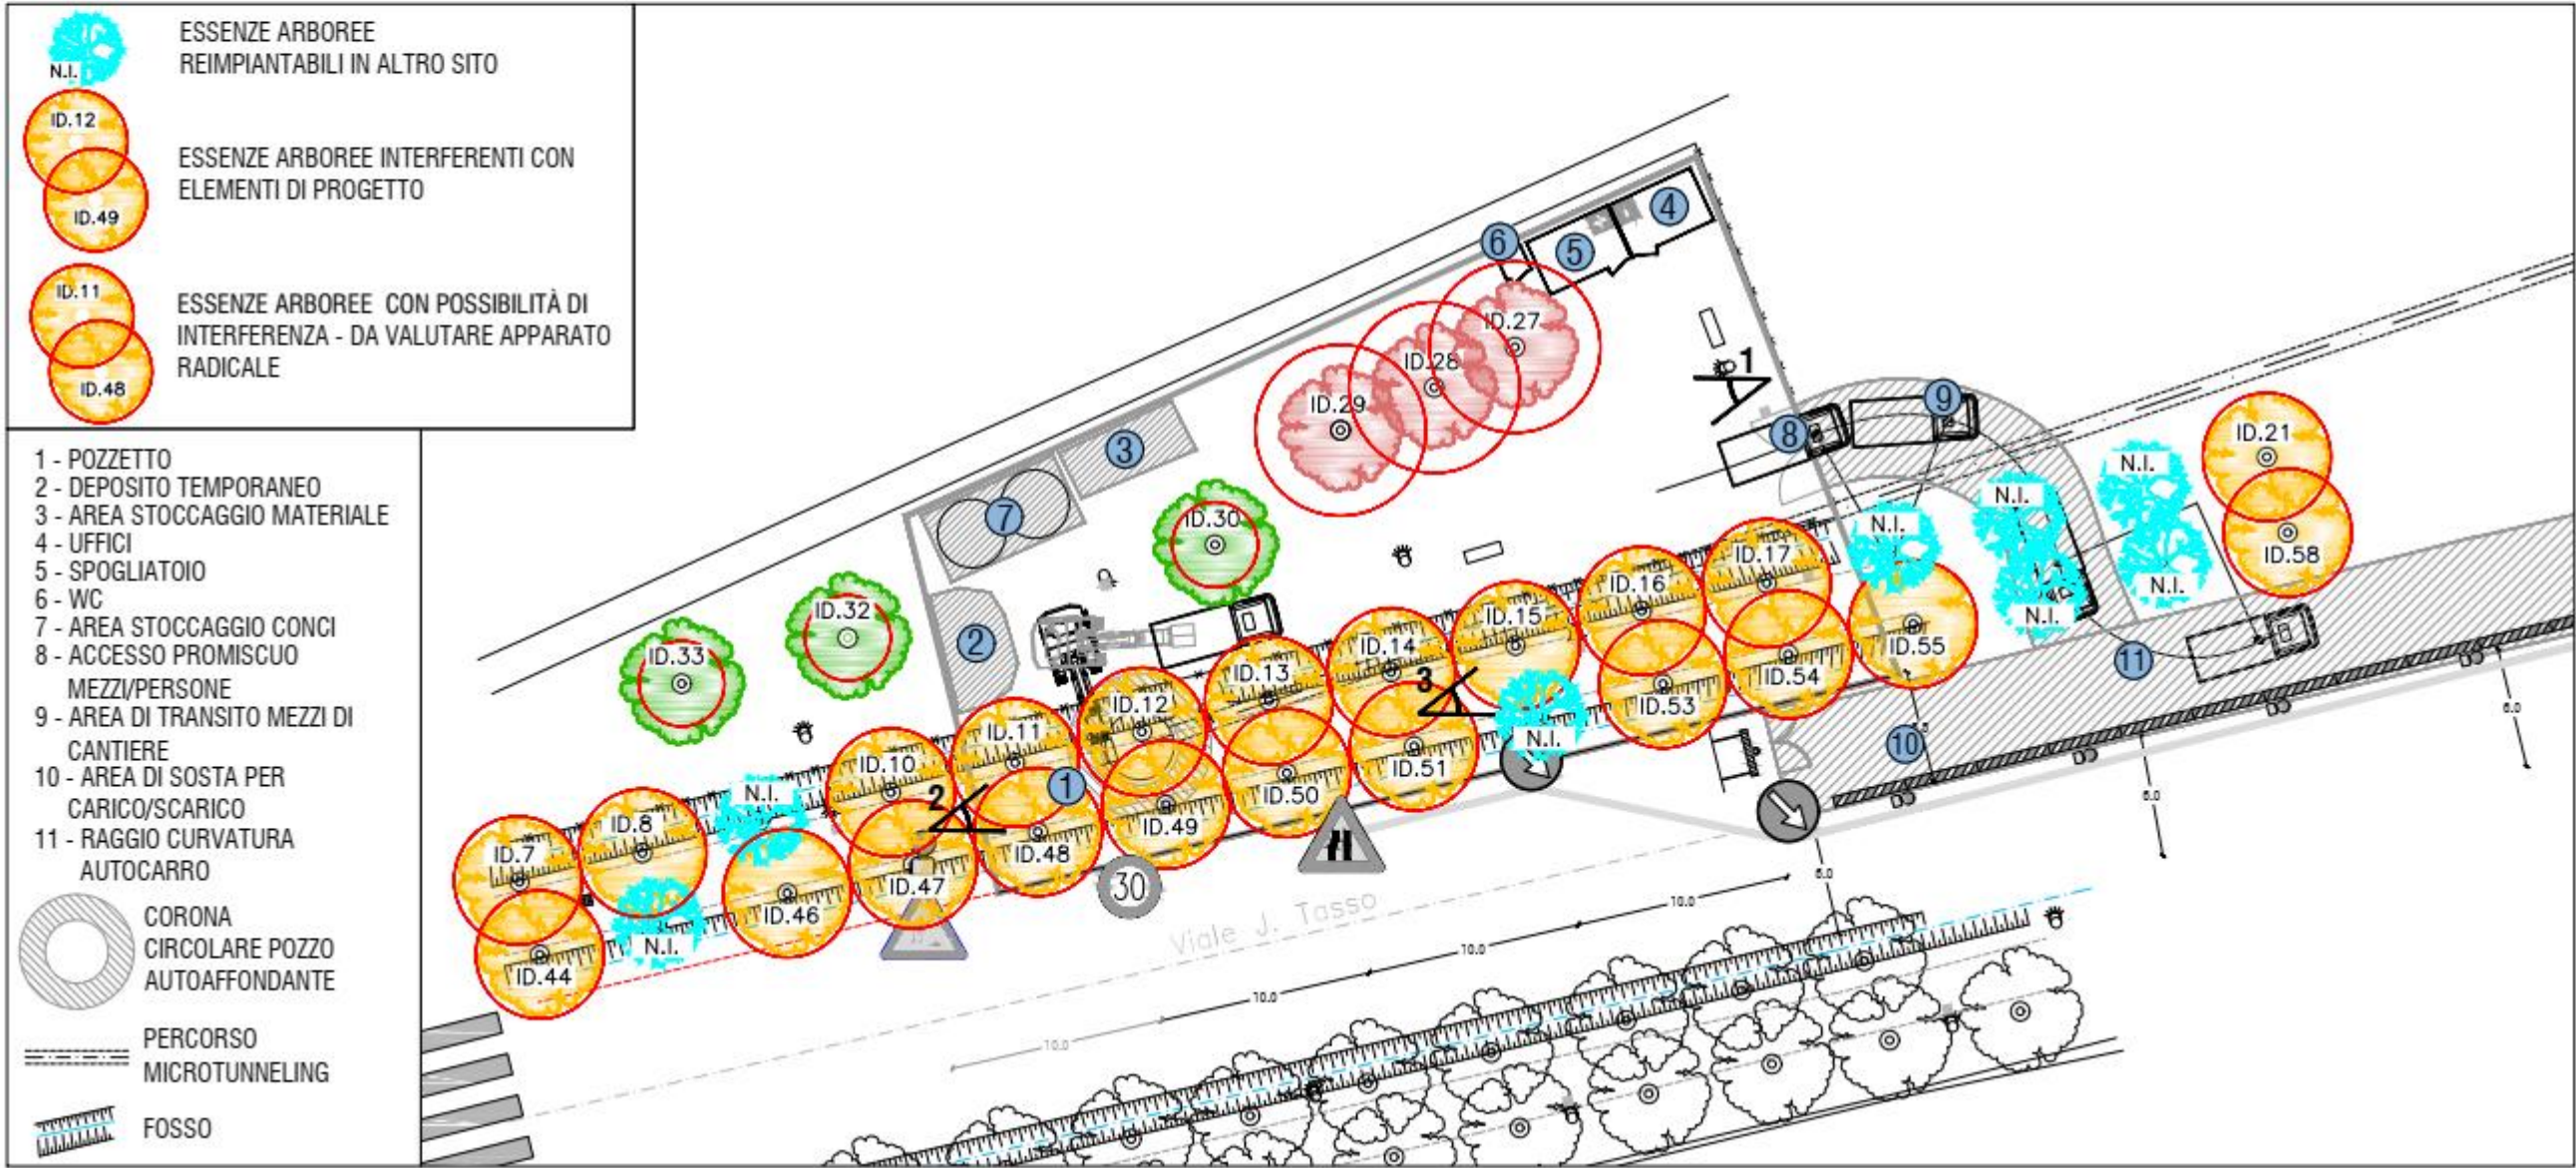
D : Inquadramento planimetrico area cantiere POZZO S03a
